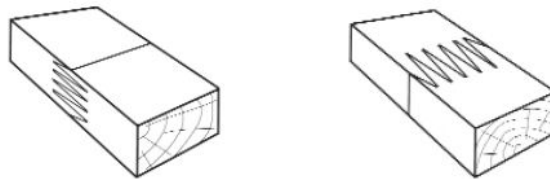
Ligações de madeira estrutural colada com finger joints (Trada, 2003a).
